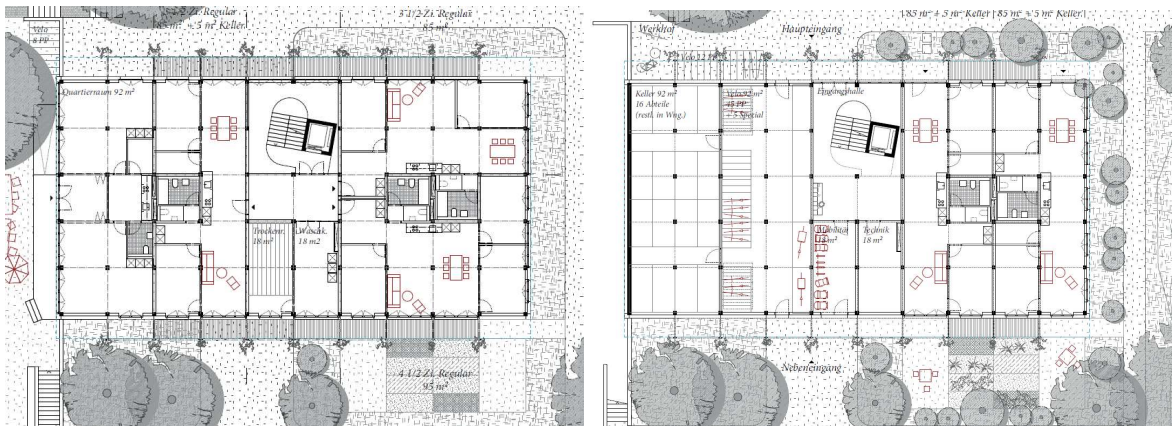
Grundrisse Gassengeschoss (links) und Gartengeschoss (rechts), ohne Masstab
